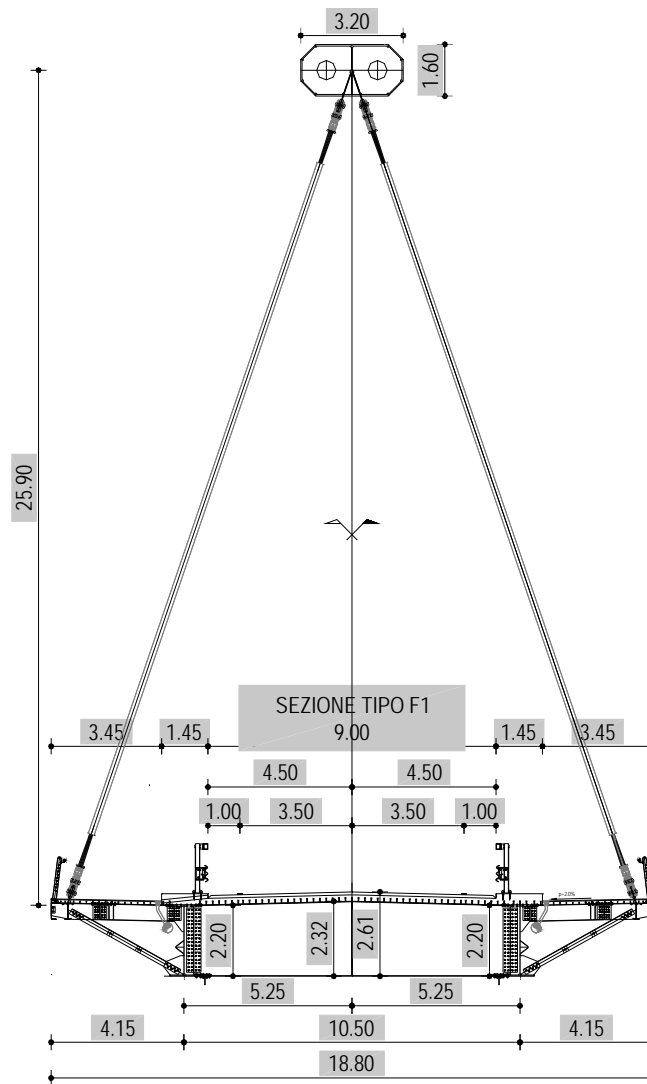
Esempio di sezione di tipo F1 in viadotto e in rettilo.
